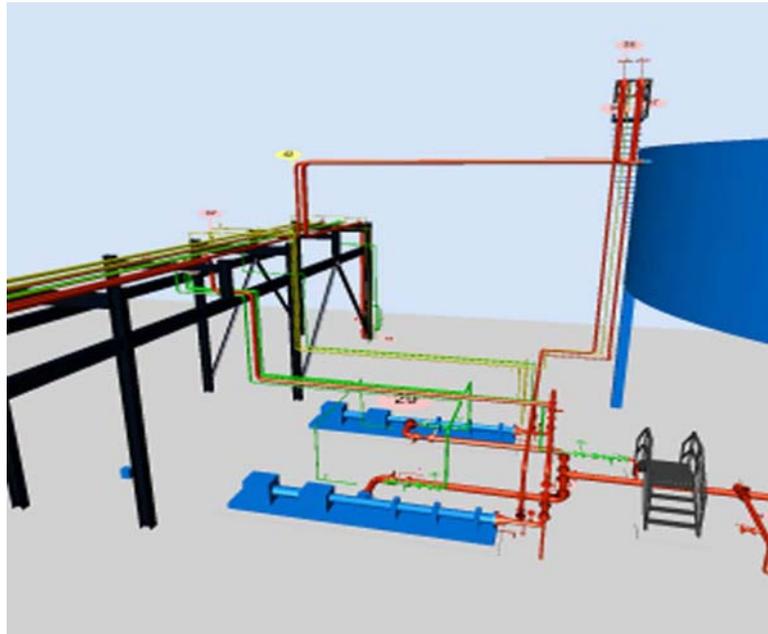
Arreglos típicos de bombas y vista en planta.
